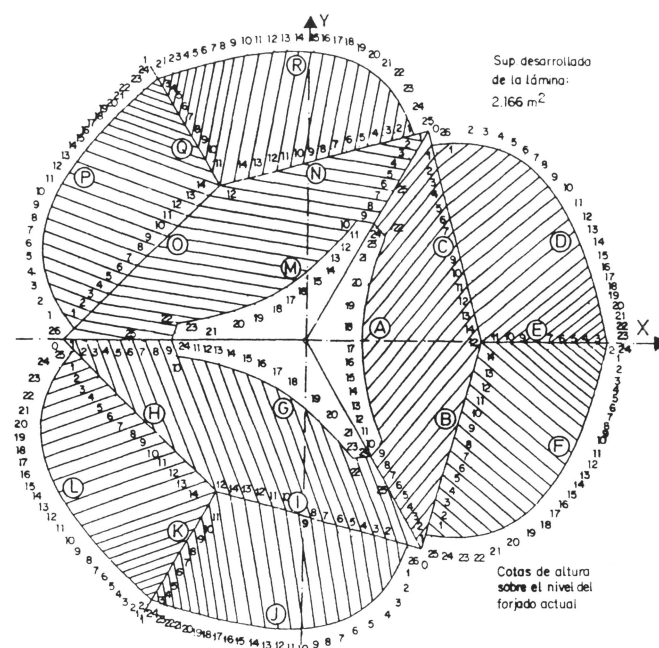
Cubierta de una Talasoterapia. Planta y alzados.
